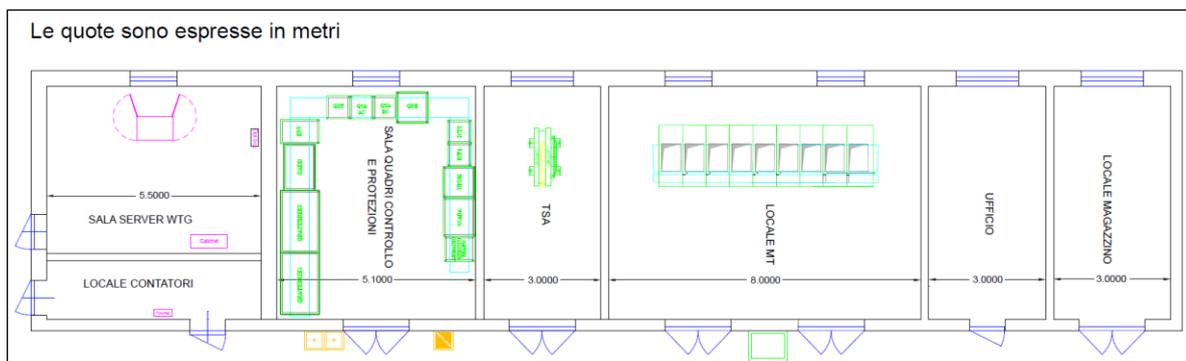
Pianta edificio di controllo SSEU
